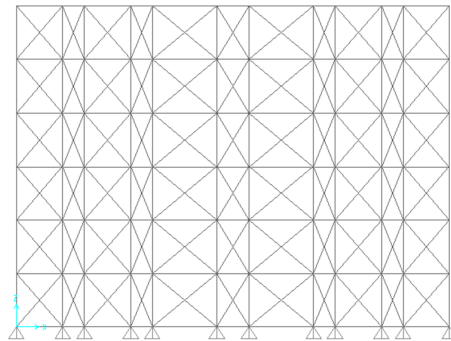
Configuração dos Planos de Contraventamento Vertical Com Elementos de Contraventamento Pequenos
